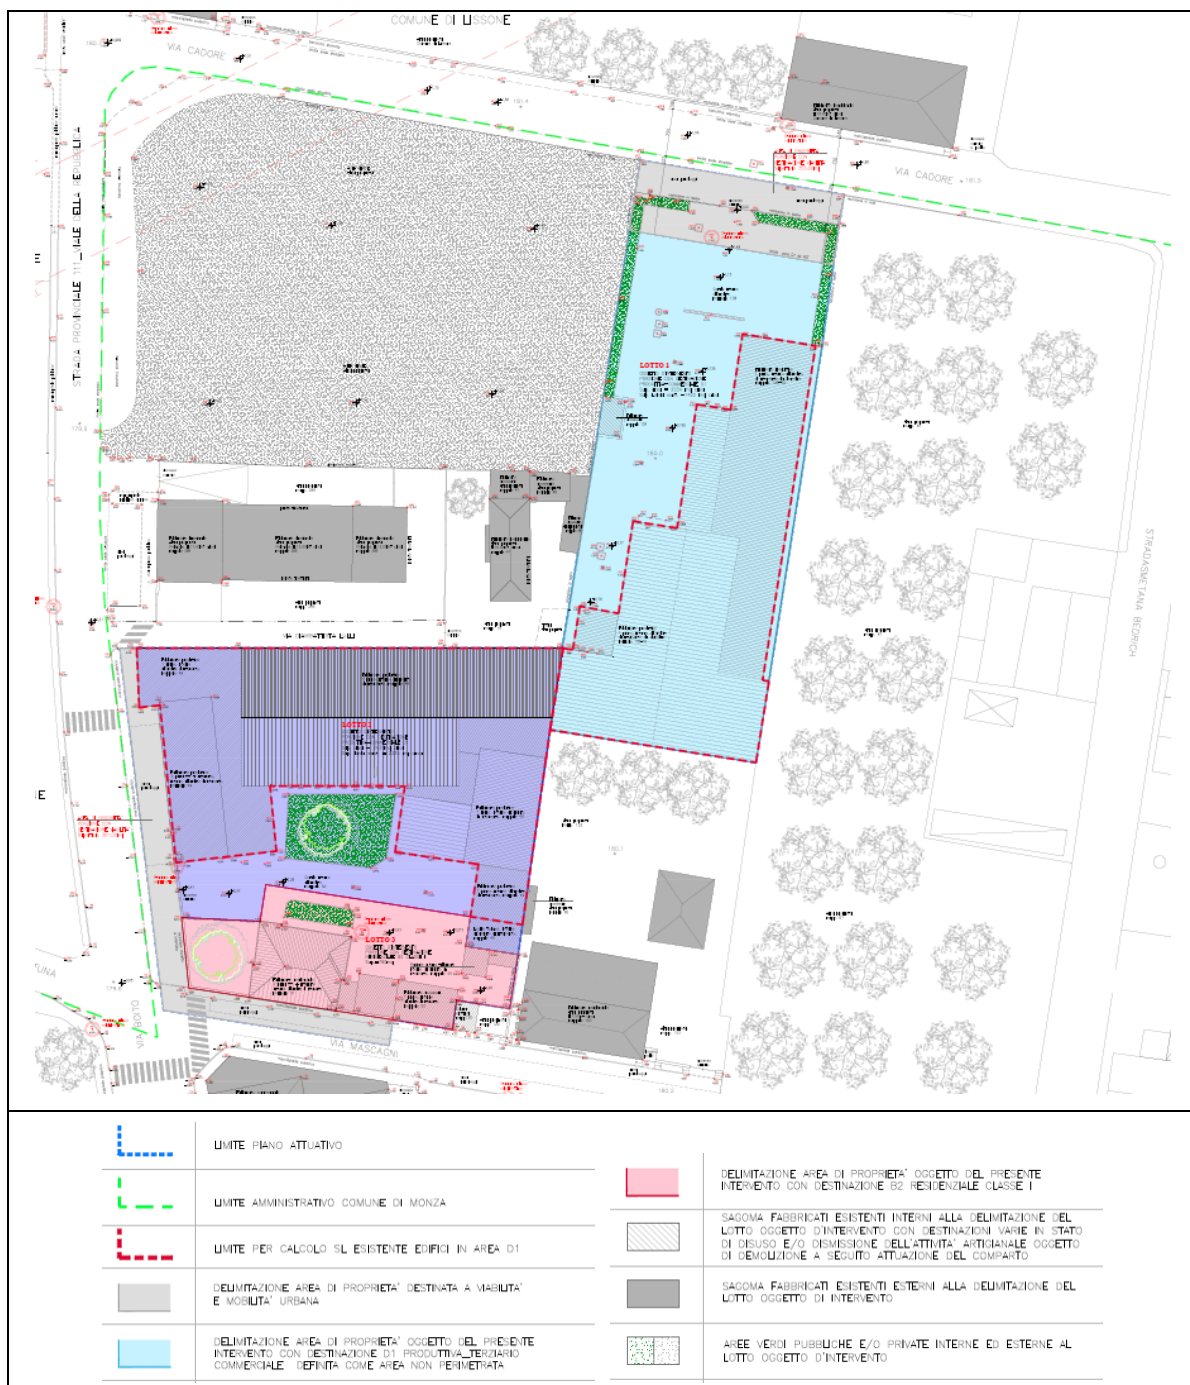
planimetria stato di fatto (estratto elaborati progetto architettonico)
